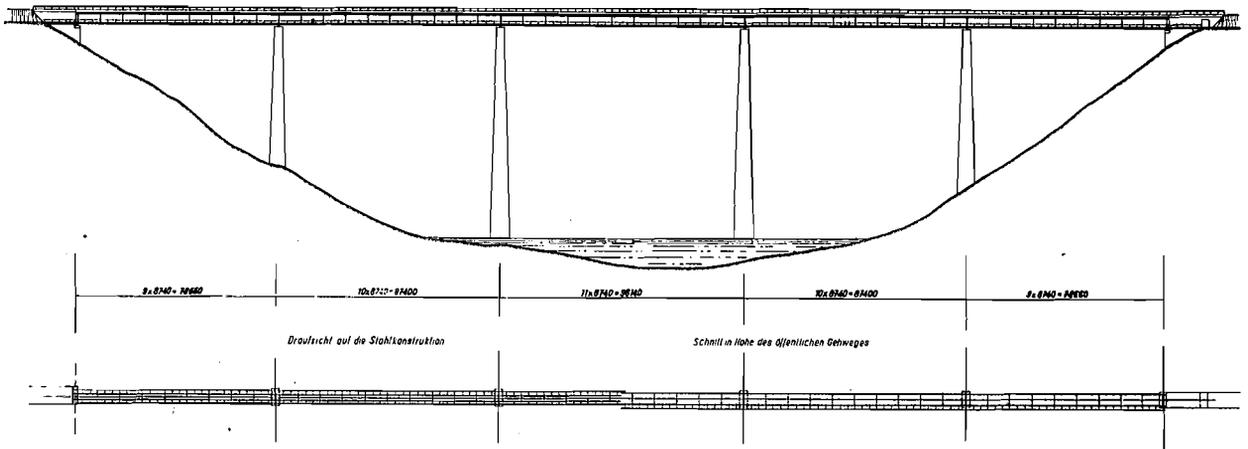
Jauntalbahn-Draubücke, Ansicht und Draufsicht
